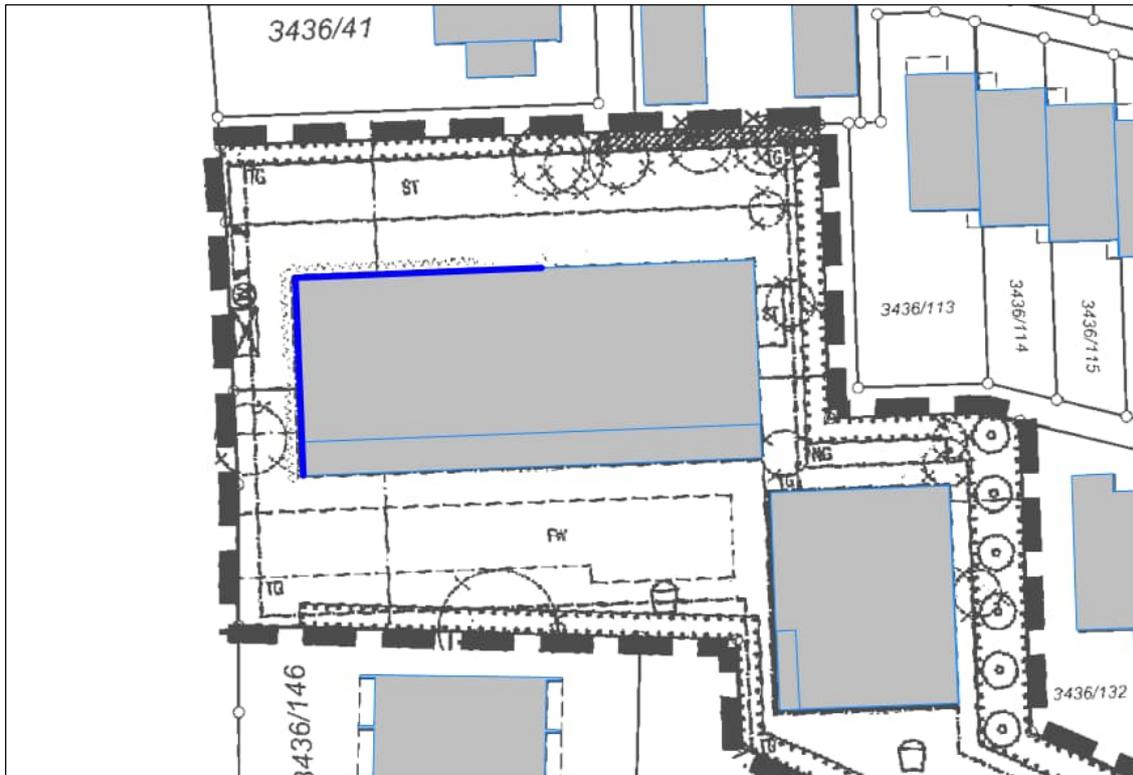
Lageplan mit Darstellung der von Immissionsgrenzwertüberschreitungen betroffenen Fassaden(-abschnitte) zur Nachtzeit
